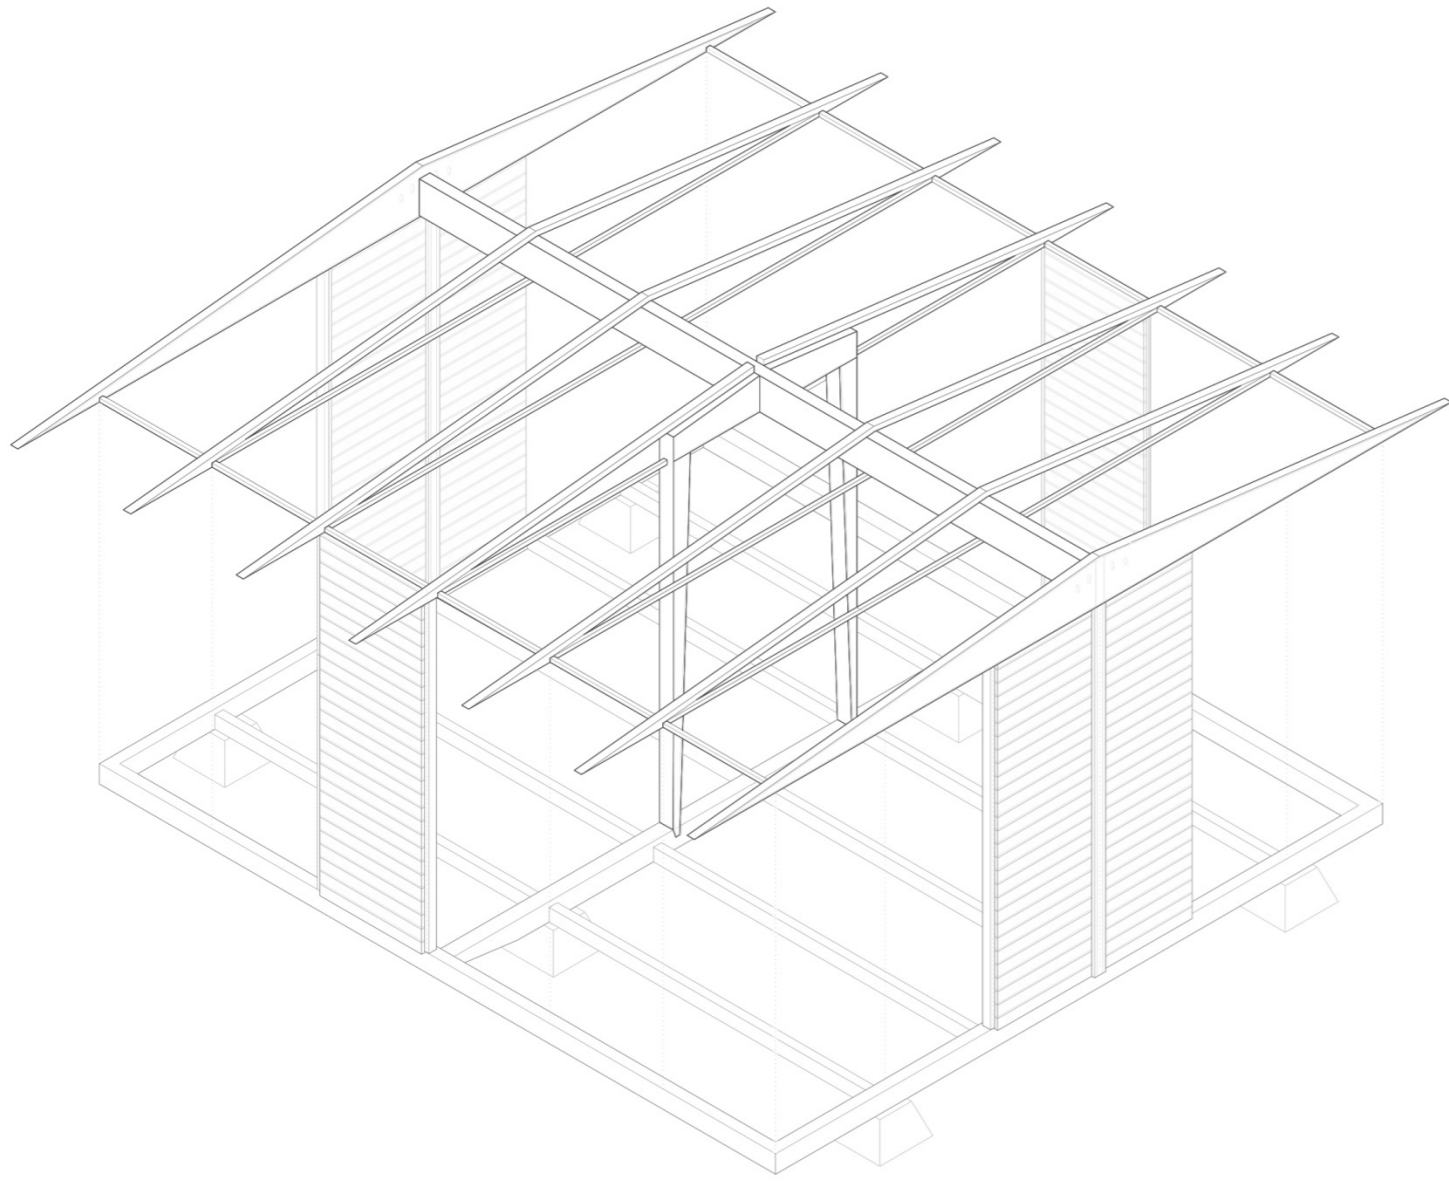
Axonometría estructural vivienda desmontable 6x6. E:1/50. Elaboración propia.
